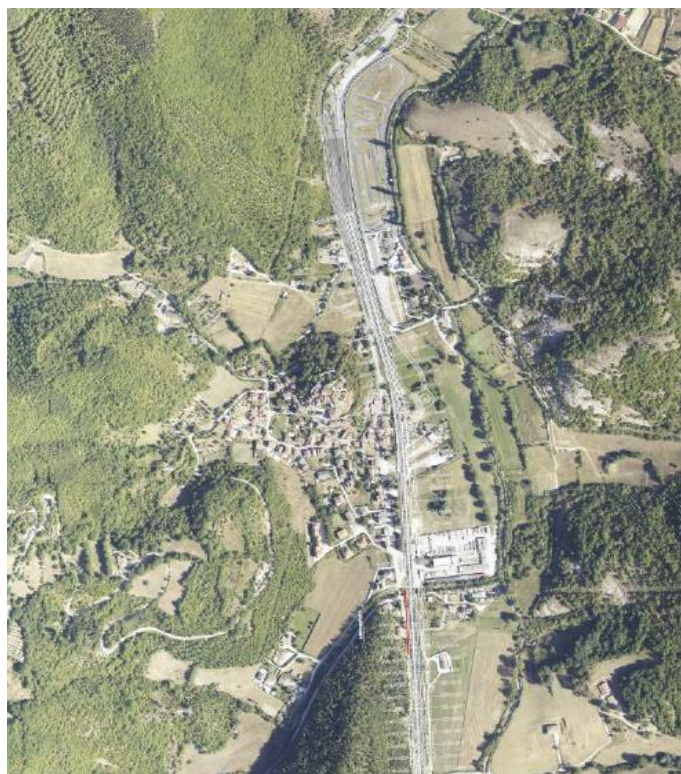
Lotto 2: tracciato di progetto su ortofoto dalla pk 5+925 alla pk 6+900
